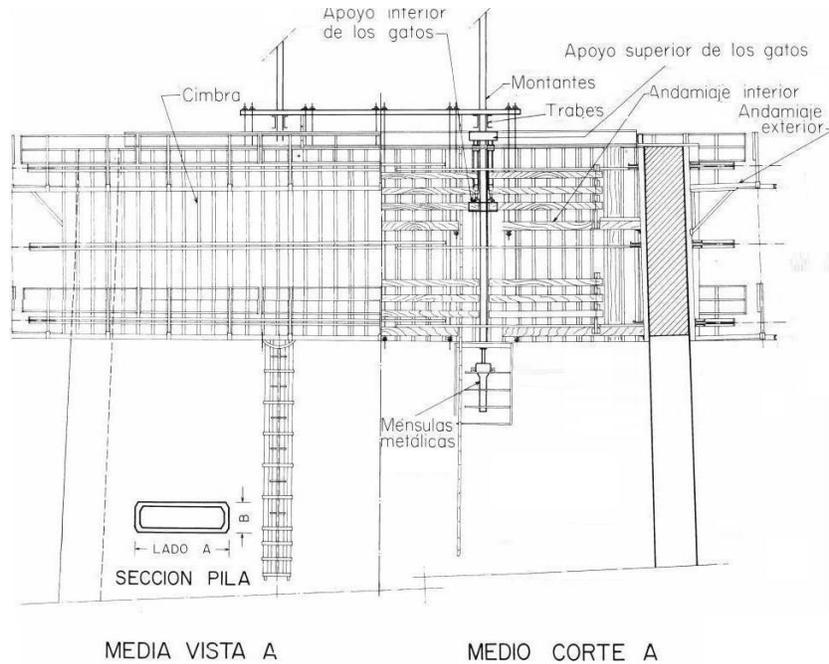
Esquema de la cimbra trepadora utilizada en el puente Metlac, vista del lado A.
